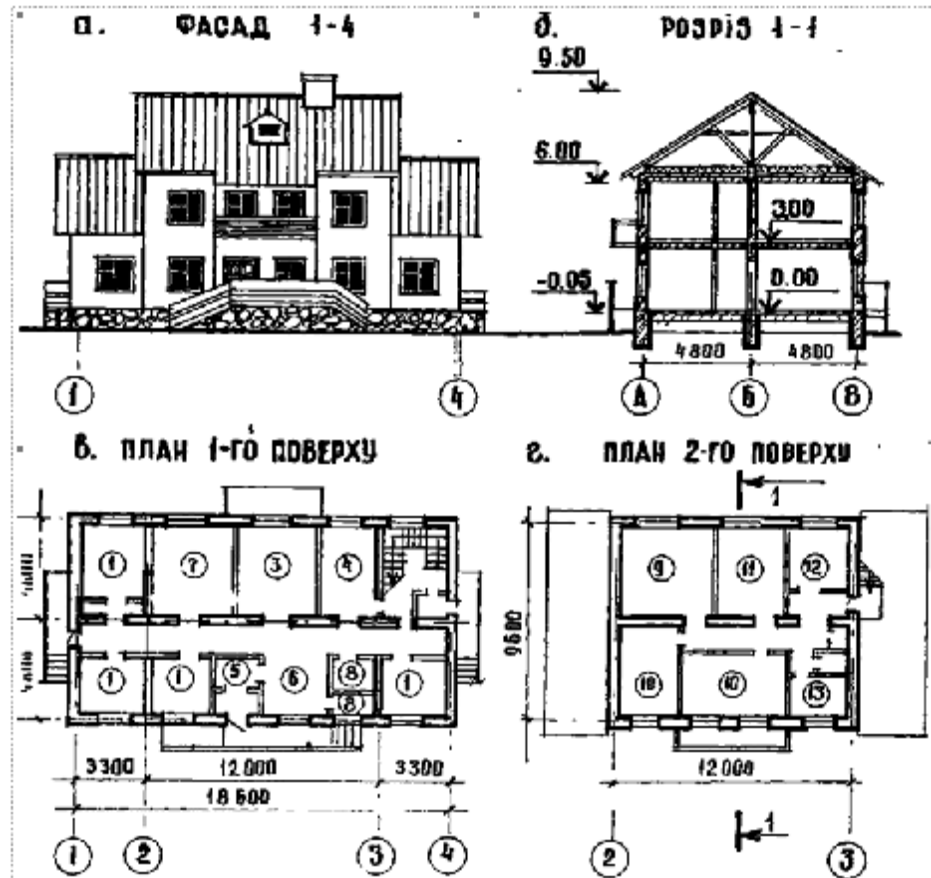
Кооперована будівля будинку ветеранів на 5 місць та 3-х кімнатної квартири: а – фасад 1-4; б – розріз 1-1; в – план 1-го поверху; г – план 2-го поверху.
